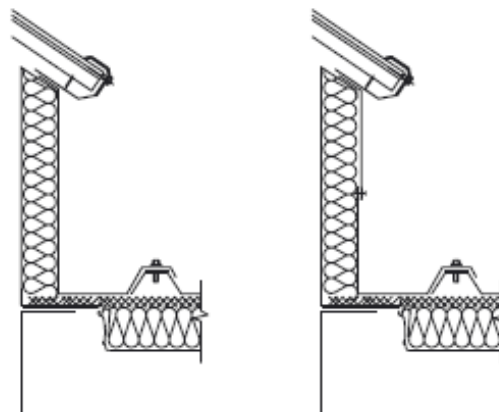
Montaż podstawy pasma świetlnego na konstrukcji żelbetowej.
